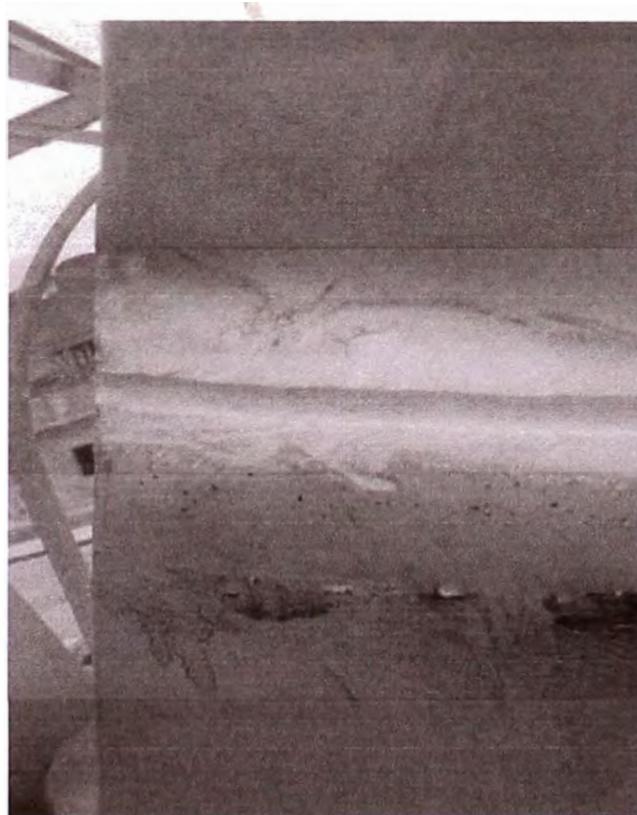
Prueba de Tintes en Empalme de Columnas
